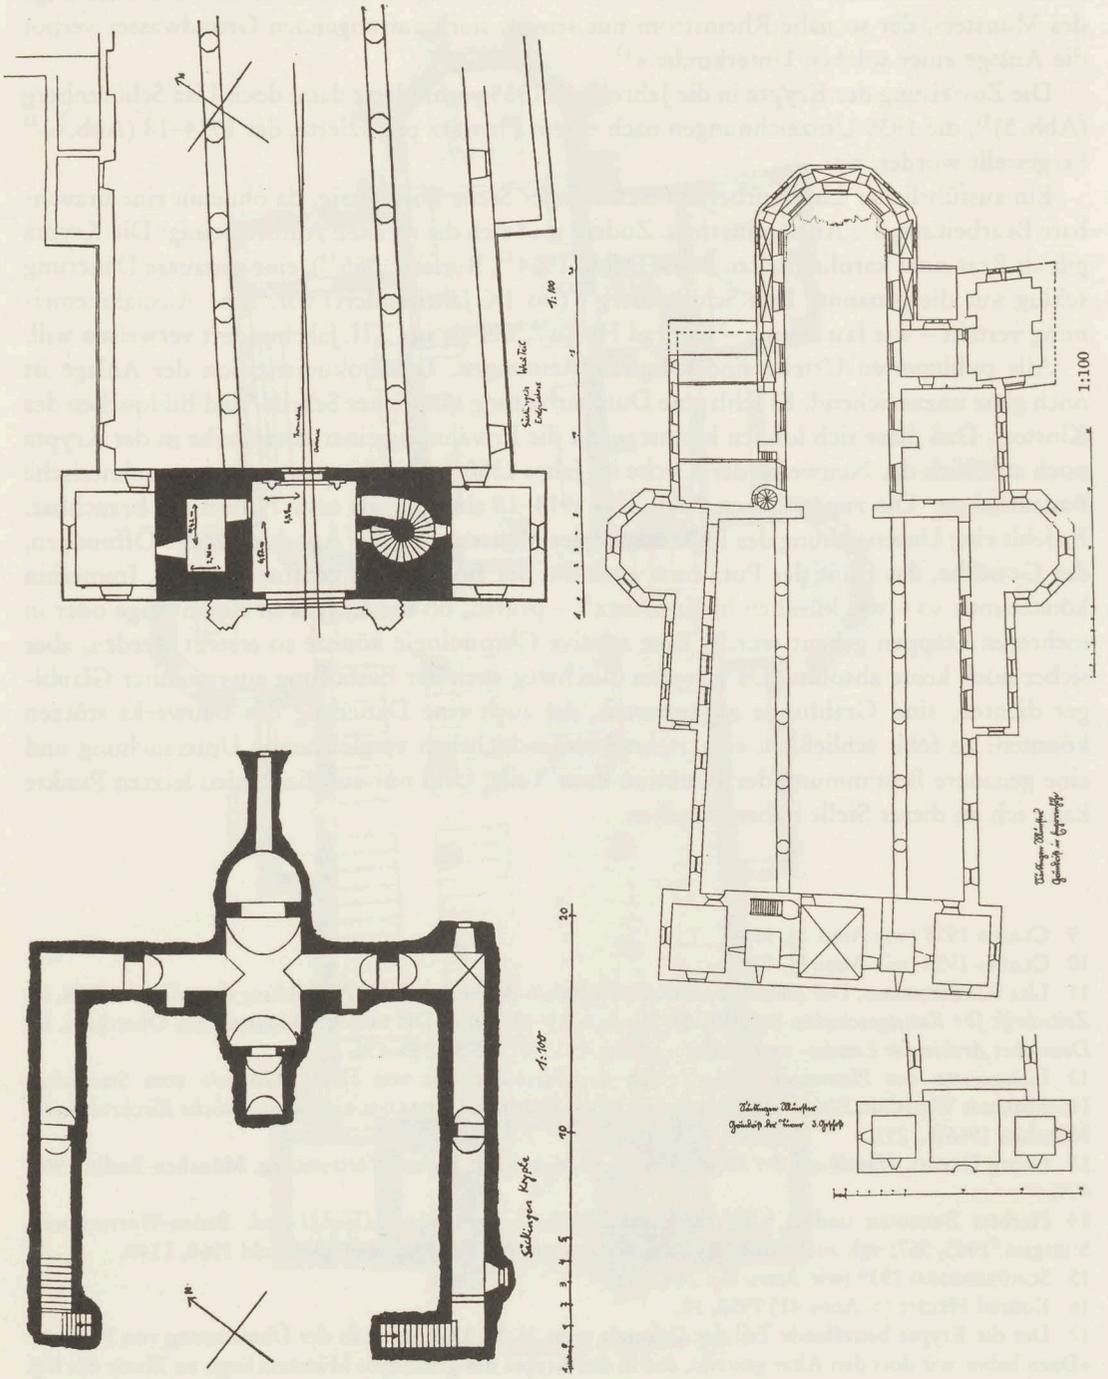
Bad Säckingen, Fridolinsmünster, Grundrisse (SCHÜRENBERG 1939, 263)
